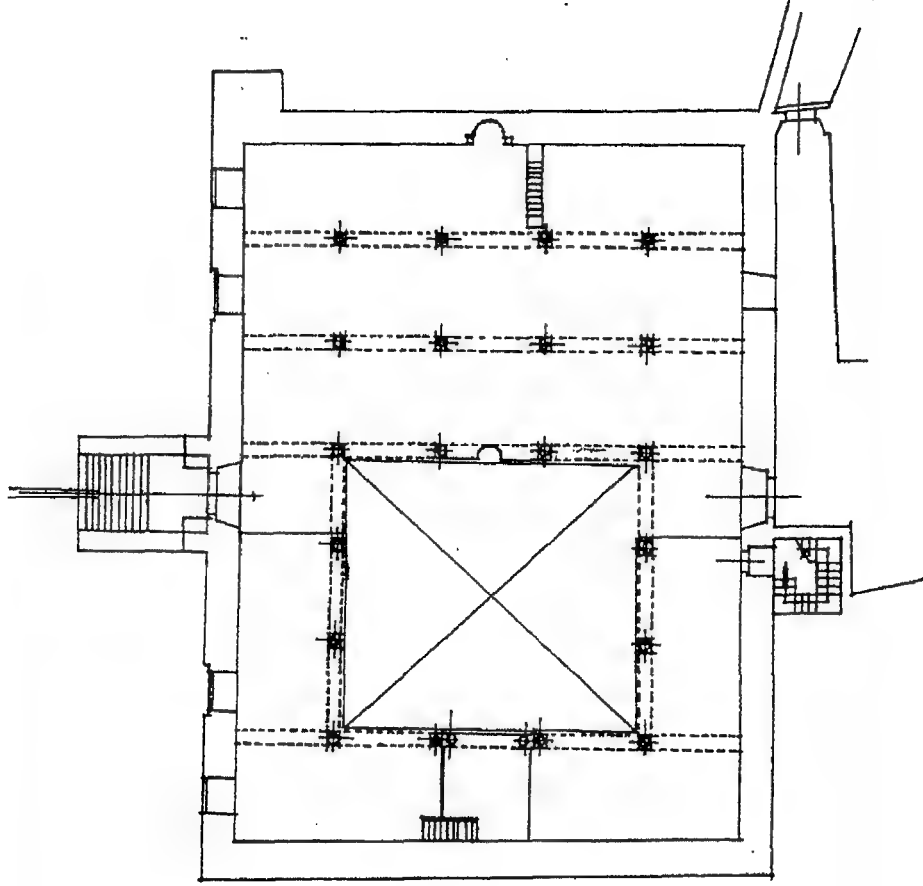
مسقط أفقى لزاوية رضوان بك الفقارى بالقريبة.
